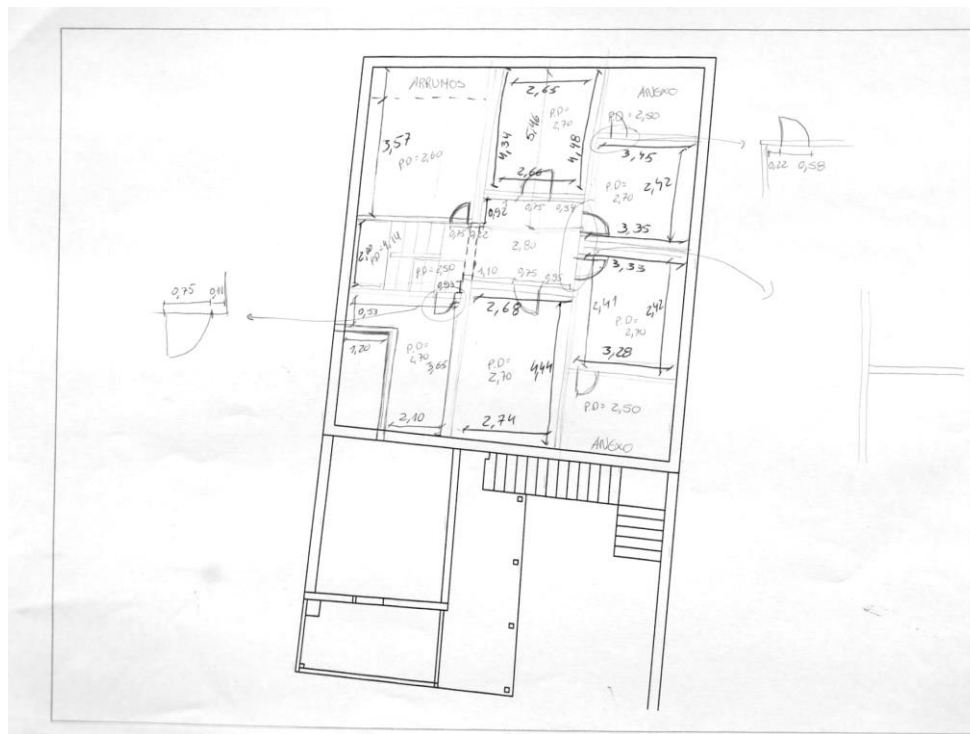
Esboço de planta do piso 2. Fonte: Ana Ferreira
